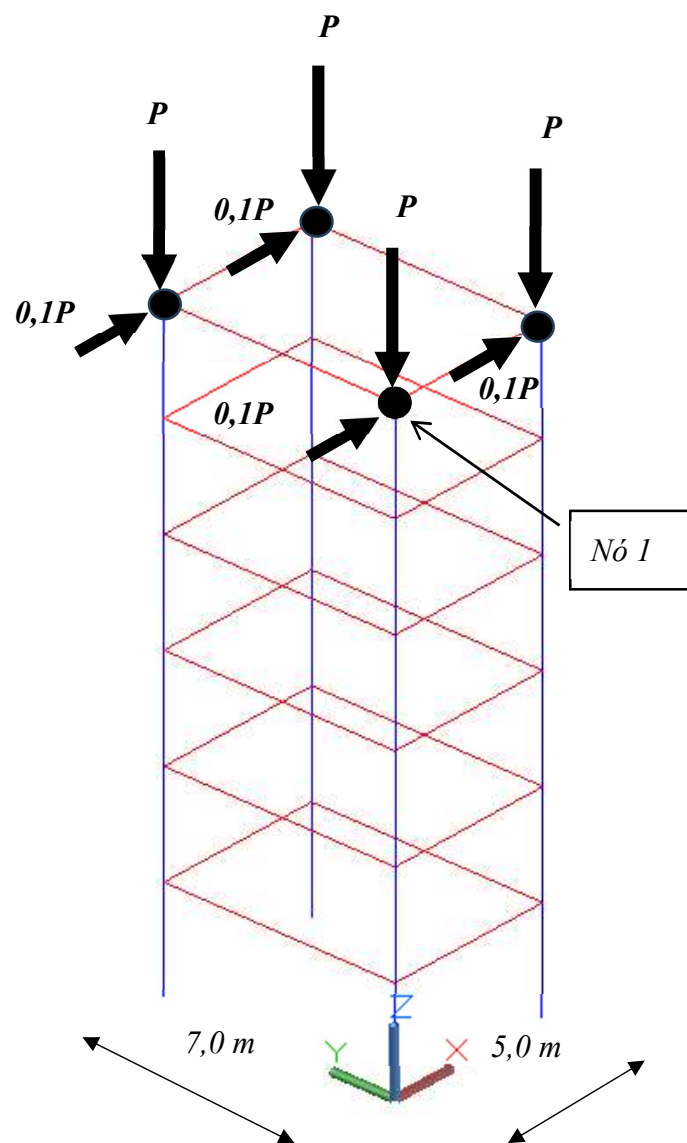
Modelo geométrico do edifício com pilares indicados em azul e vigas indicadas em vermelho.
